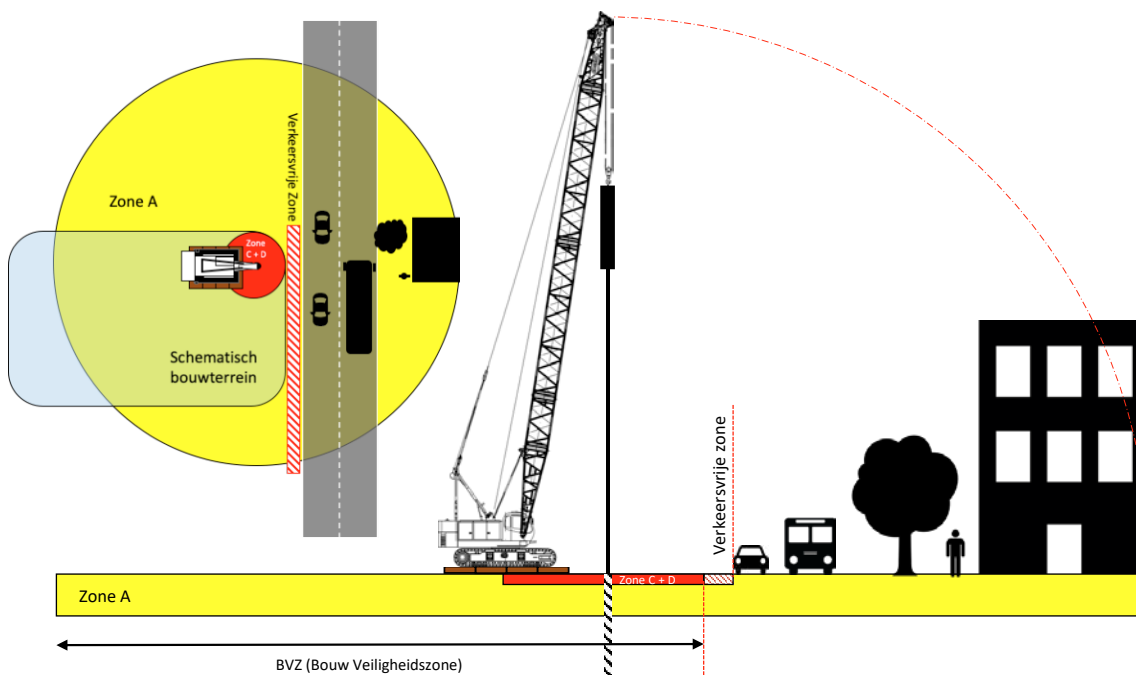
Overzichtstekening hijsen met PD-stelling/giekstelling & GLS-stelling/vouwstelling/sheetpilar – type sheetpilar (hoofdgroep B en C)
